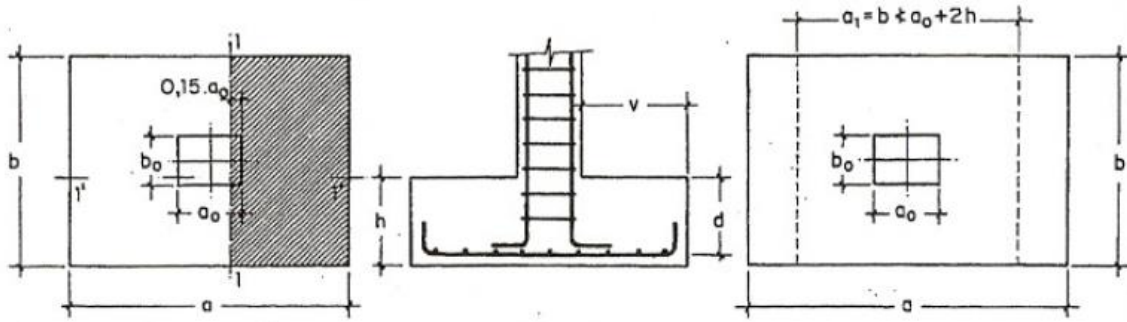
Armadura de tracción en zapata aislada, Montoya-Meseguer-Moran
